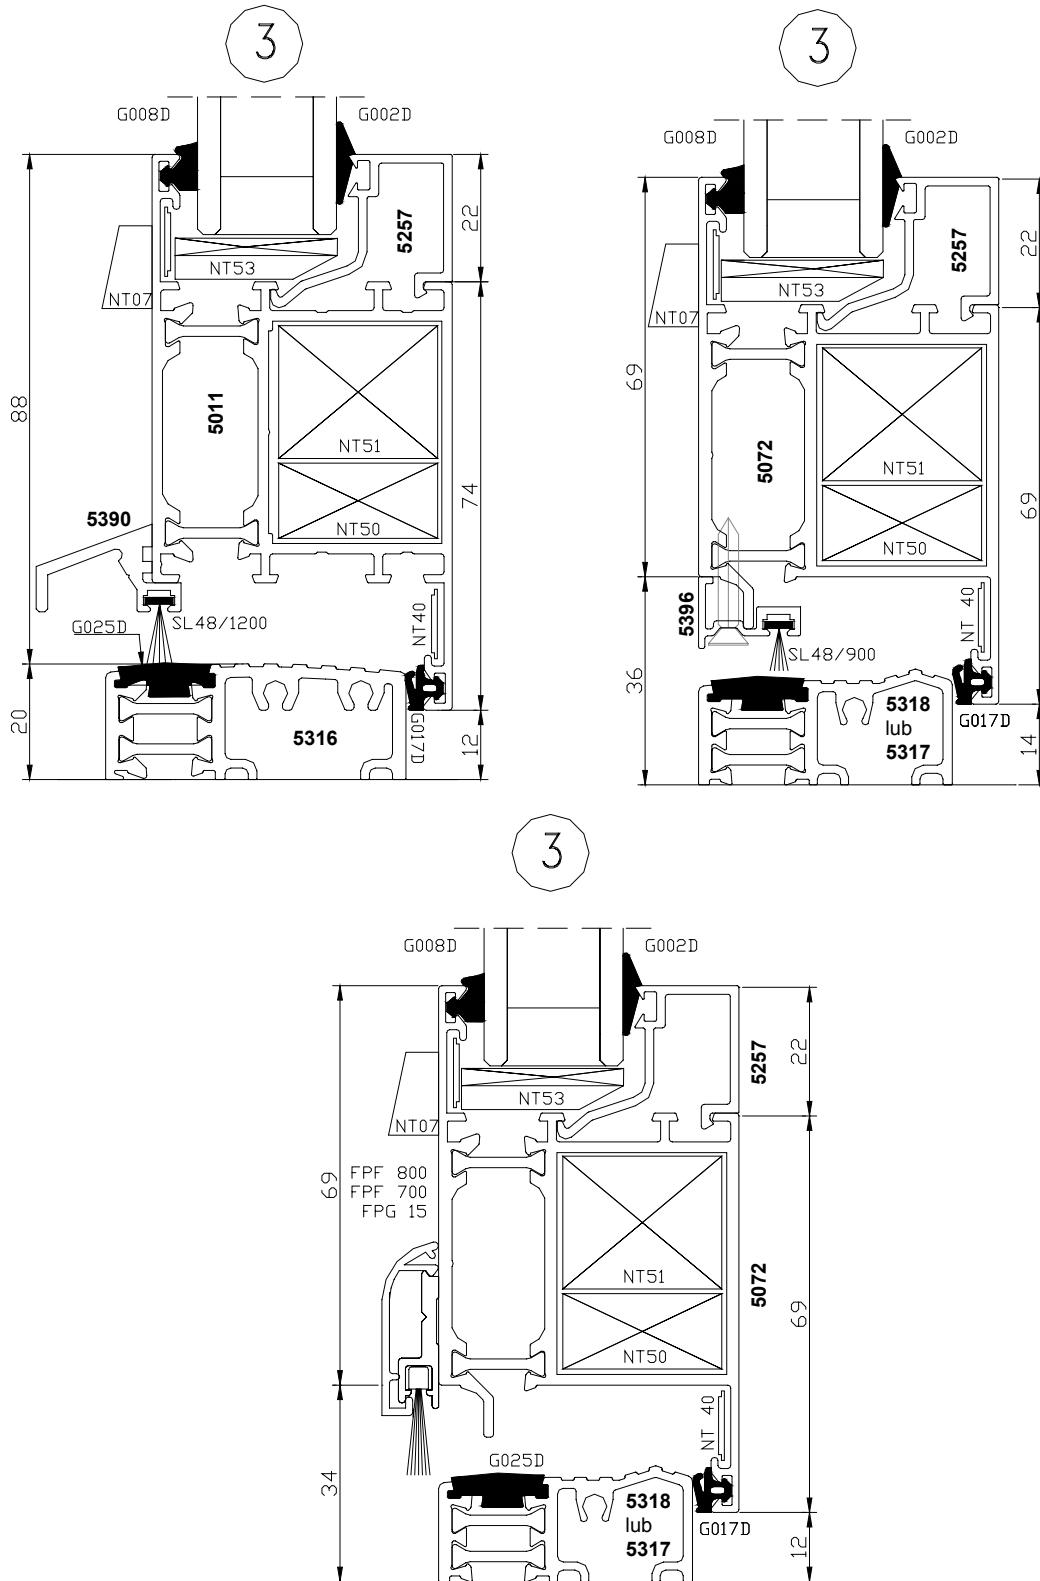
Schematy konstrukcji drzwiowych, oznaczenia przekrojów
